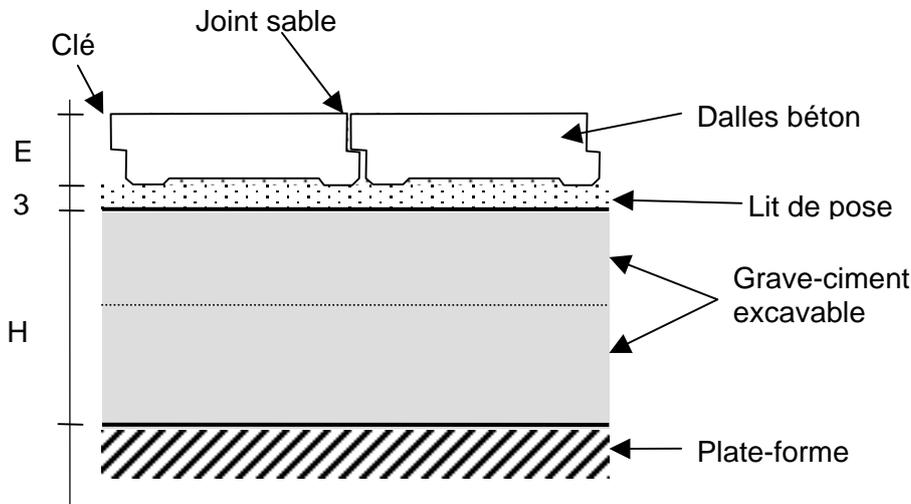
coupe verticale de la CUD à dalles emboîtées (cotes en cm)
